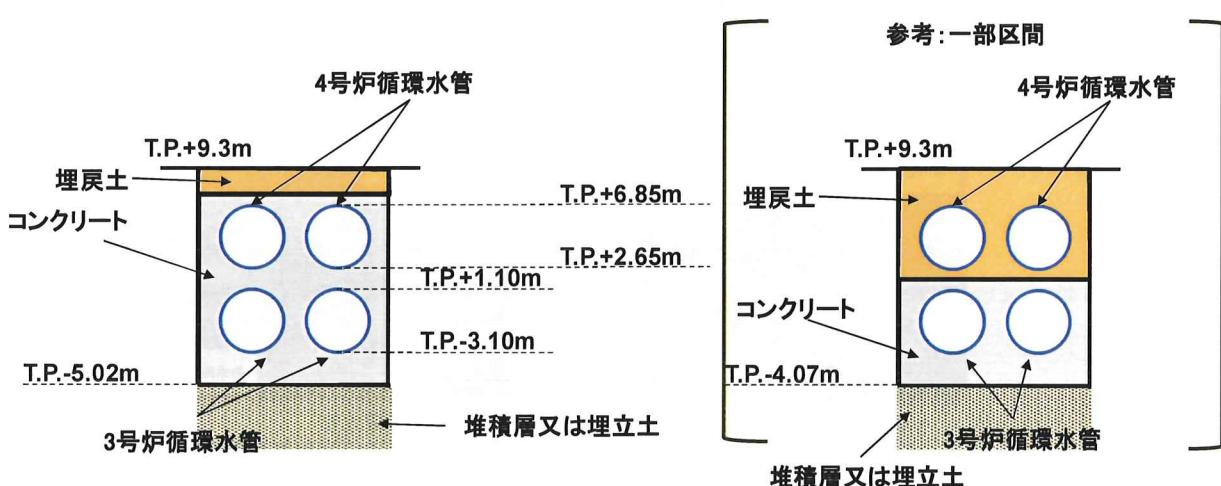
3, 4号炉循環水管埋設部④断面図
